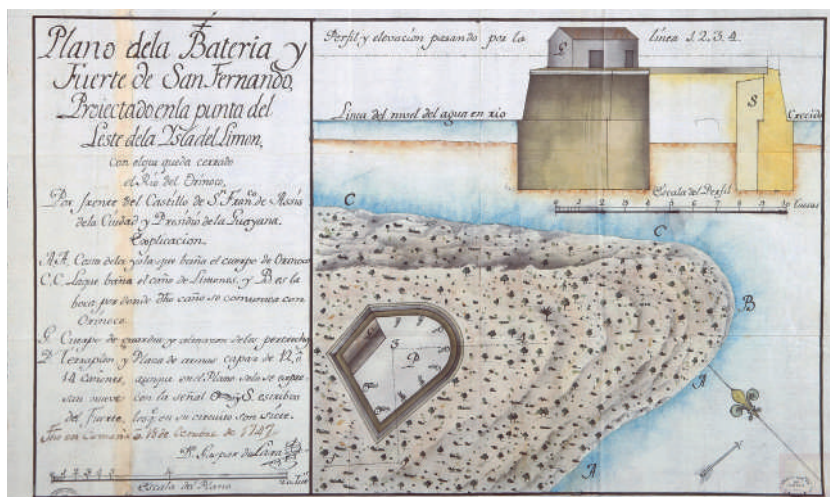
Planta de la primera propuesta para la batería de San Fernando (Lara, Gaspar de. 1747. «Plano de la batería y fuerte de San Fernando proyectado en la punta del leste (sic) de la ysla de Limón, con el que queda cerrado el río Orinoco por frente del castillo de San Francisco de Assis de la ciudad y presidio de la Guayana». Guayana, 18 de octubre de 1747. En AGI, sign. MP-Venezuela, 131)
